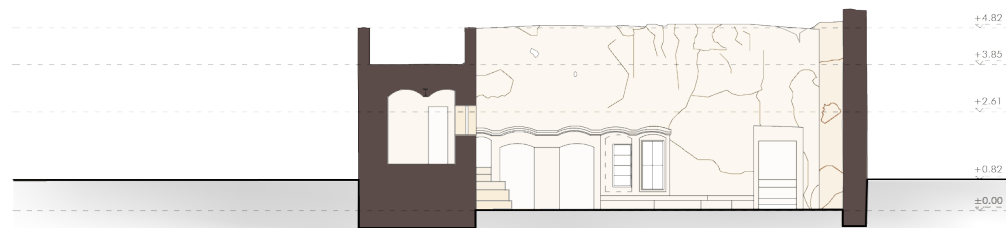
Sezione A-A della casa 8. Scala 1/200
